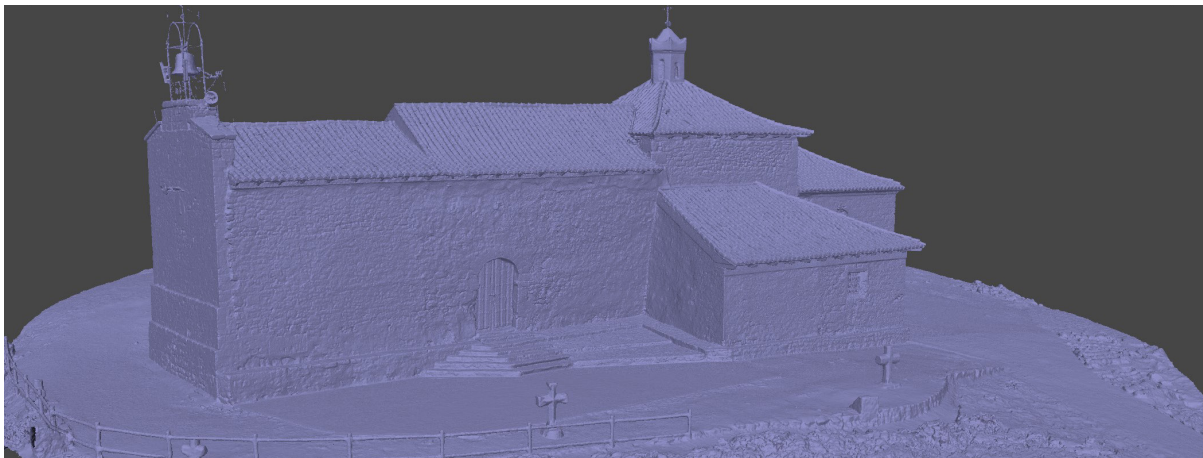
Levantamiento exterior de la Ermita. Modelo sólido. Fuente: Elaboración propia
